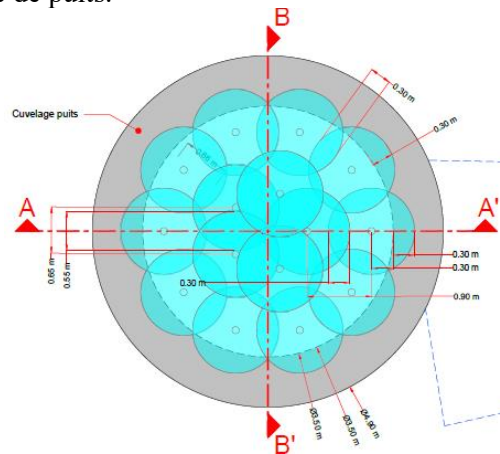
Vue en plan du bouchon en colonnes sécantes de jet grouting – Hypothèse colonne sécante de diamètre 1,2 m
